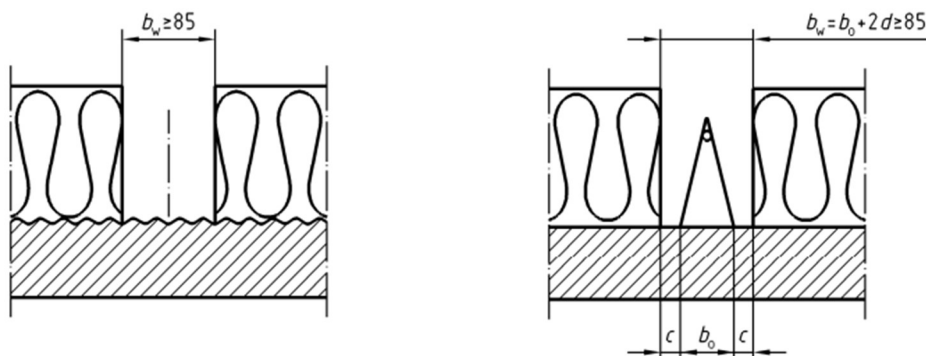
distanza minima tra gli elementi di alleggerimento
